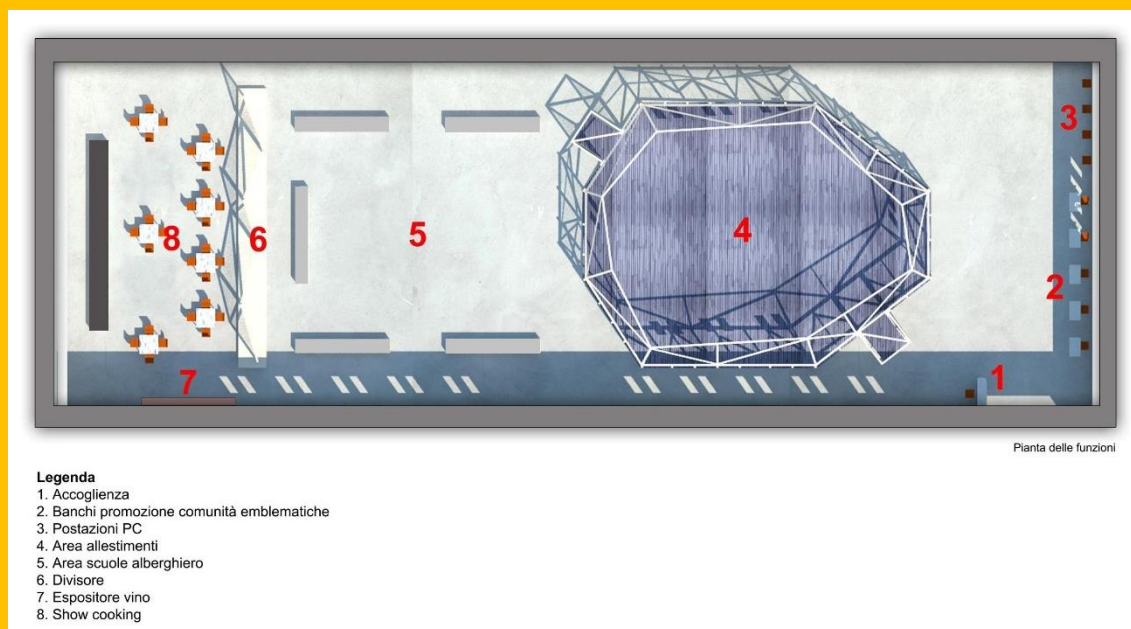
PLANIMETRIA CON LE FUNZIONI ALL'INTERNO DEL PADIGLIONE A. © GAMBARDELLA ARCHITETTI
